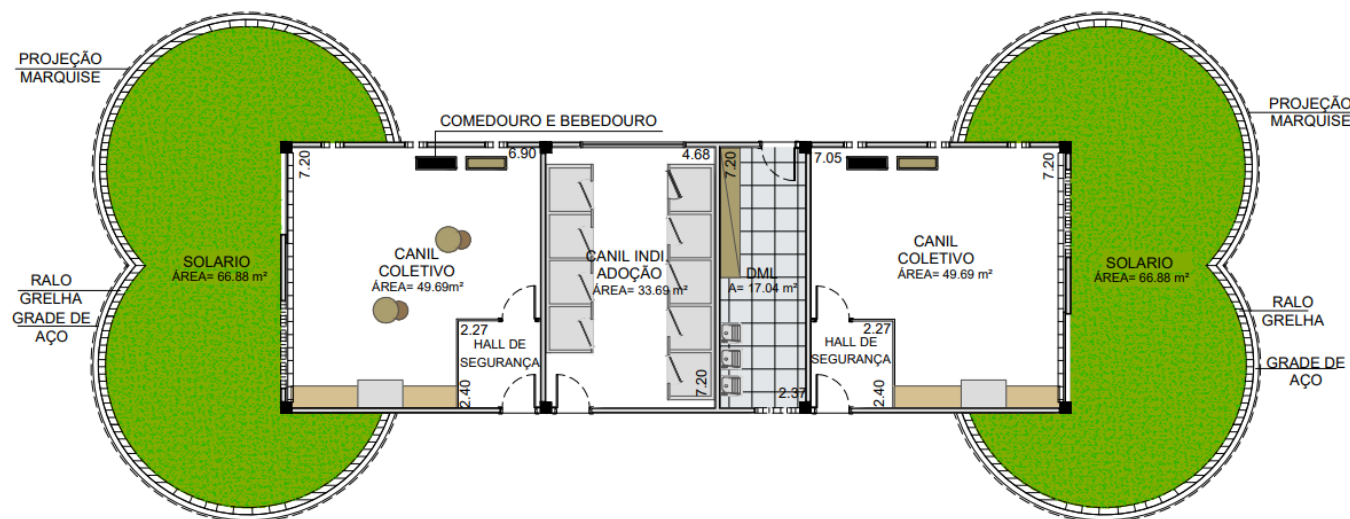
Planta baixa humanizado canis individuais pequeno porte.
